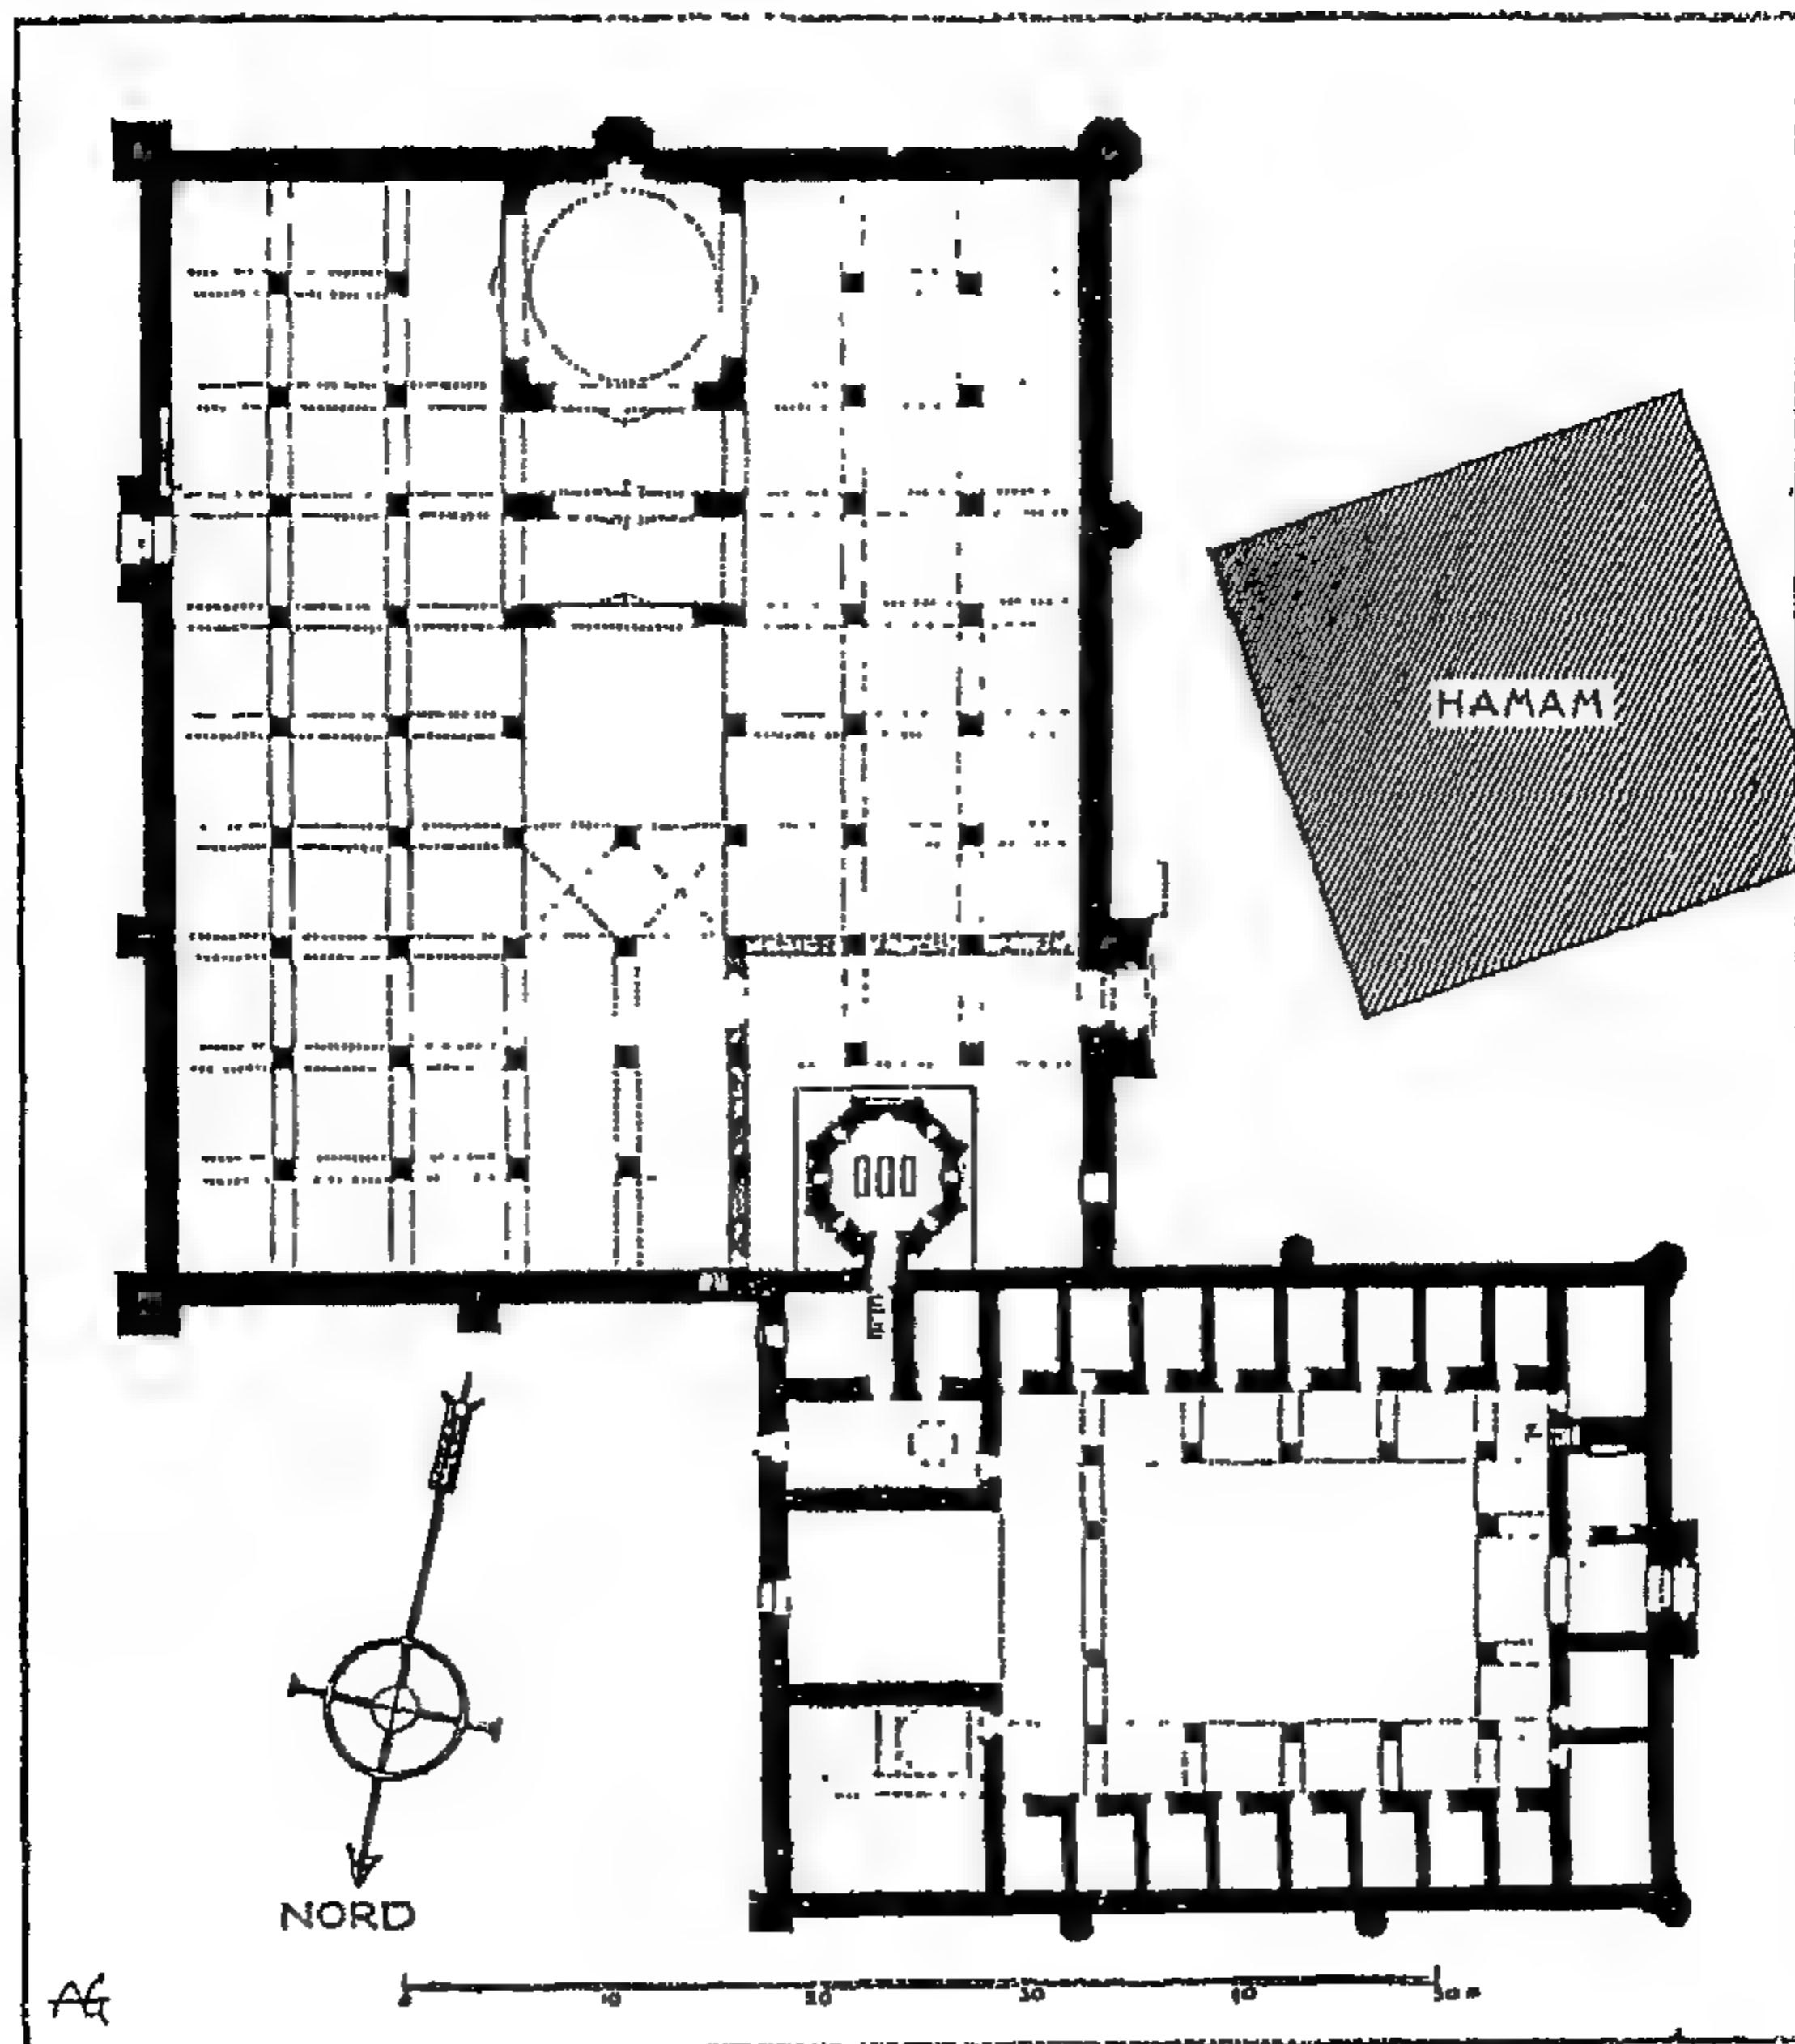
مسقط أفقي لمدرسة انجه مناره لي في قونية (الوزير صاحب عطا) ٦٥٩هـ / ١٢٦١م : مسقط أفقي .
